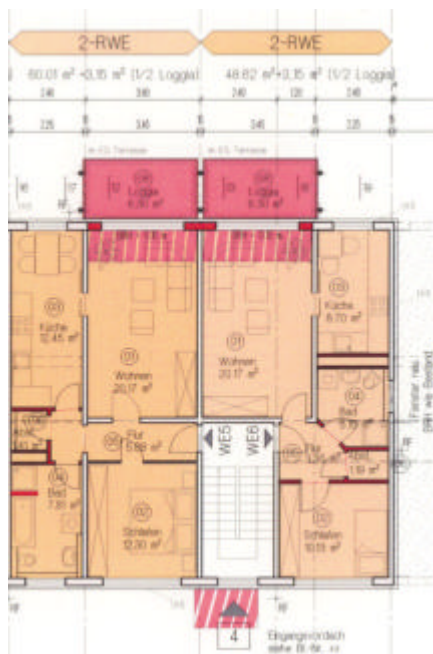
Grundrisse der Zweiraumwohnungen Tallinner Straße 36 und 38
